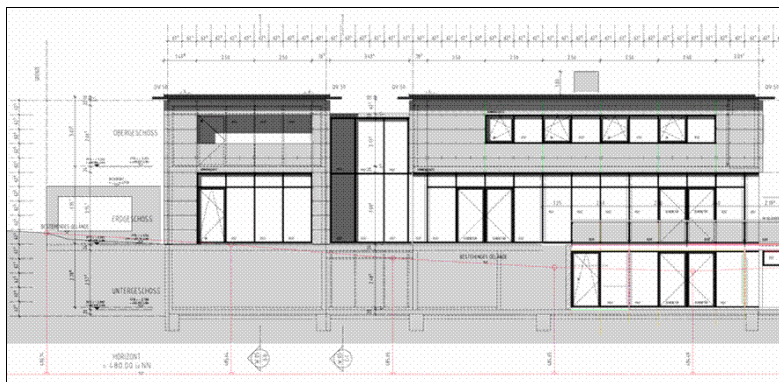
oben: Ansicht des geplanten Gebäudes aus Betonfertigteilen. Man erkennt die für den VIP-Einbau notwendige horizontale und vertikale Rasterung.
